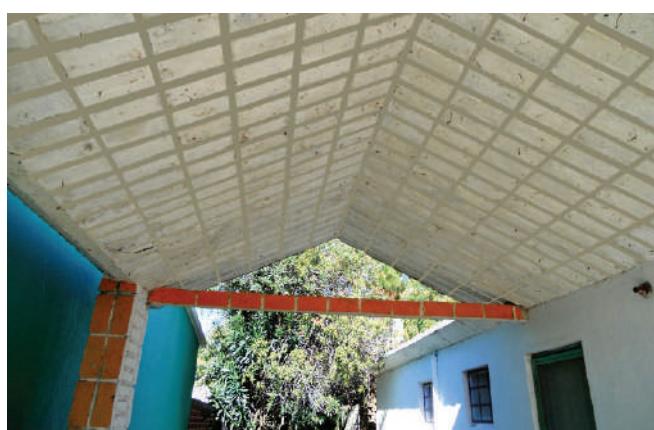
A viga tensor é de tijolo armado para evitar a separação das duas águas. (*-5).
